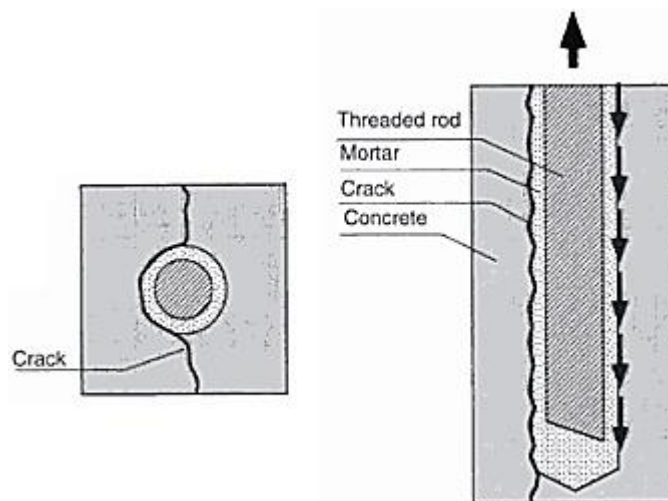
Ancoragens instaladas em betão fendilhado [30]
